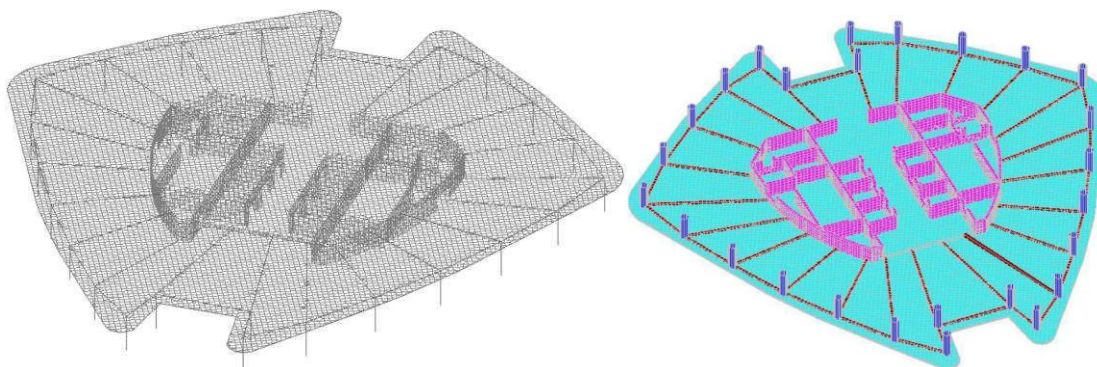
Розрахункова схема плити перекриття по балках
